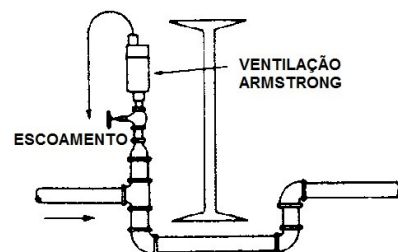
Instalação de ventilação automática em ilhé de tubagem
